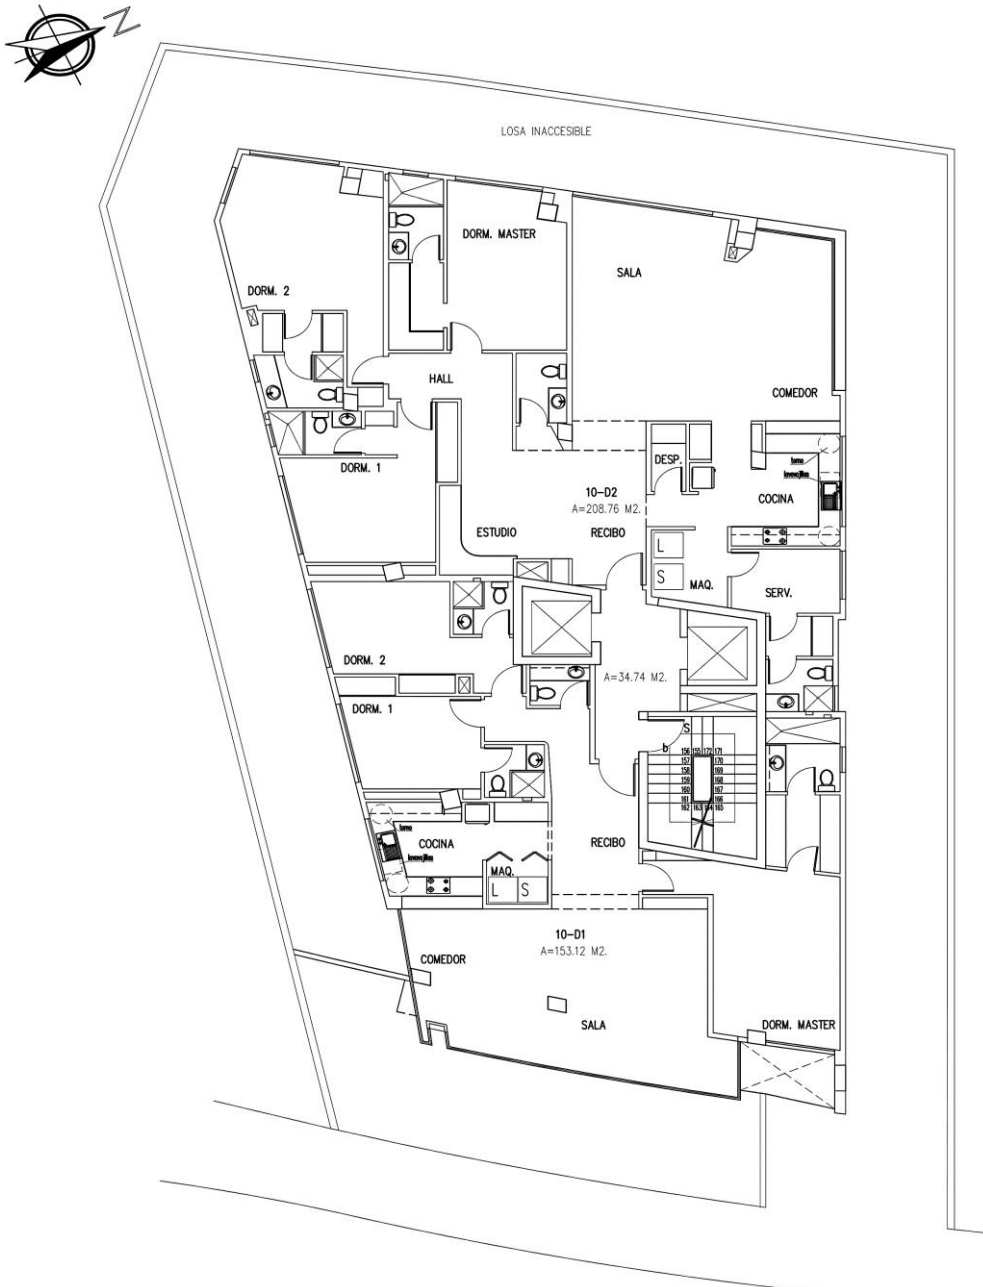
Planos Arquitectónicos Edificio Bohème – Planta 6, 7, 8,9
